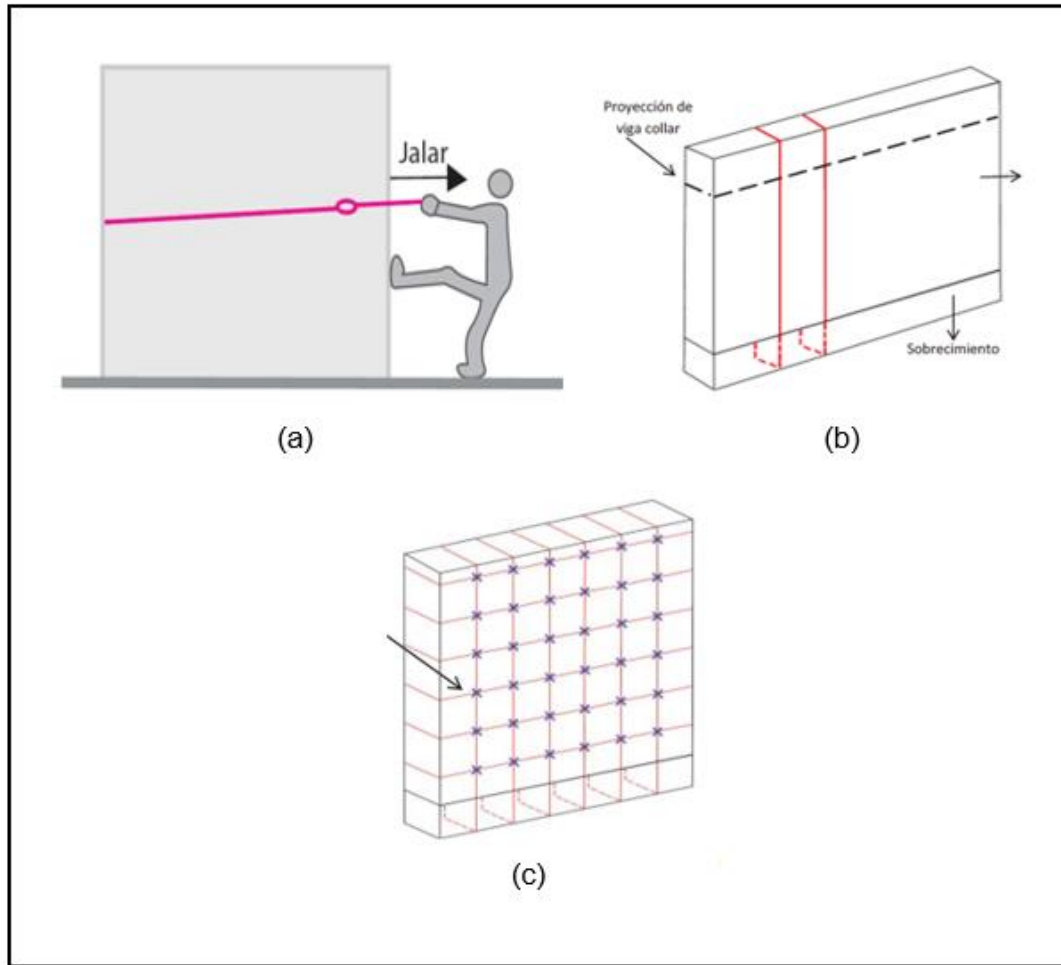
Refuerzo con driza (Fuente: El Peruano: 2017, 23, 24)
